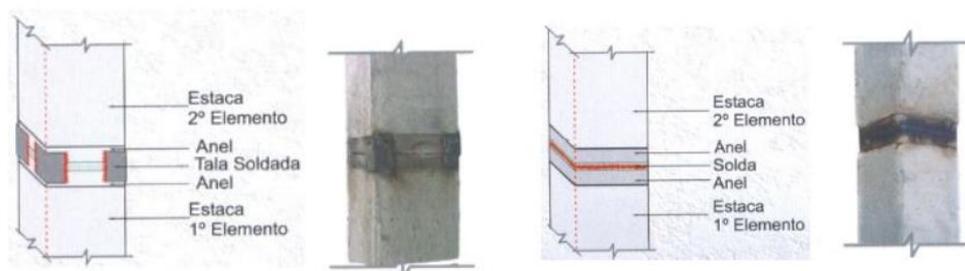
Emenda de estaca por tala soldada (esq.) e por anel soldado (dir.)
